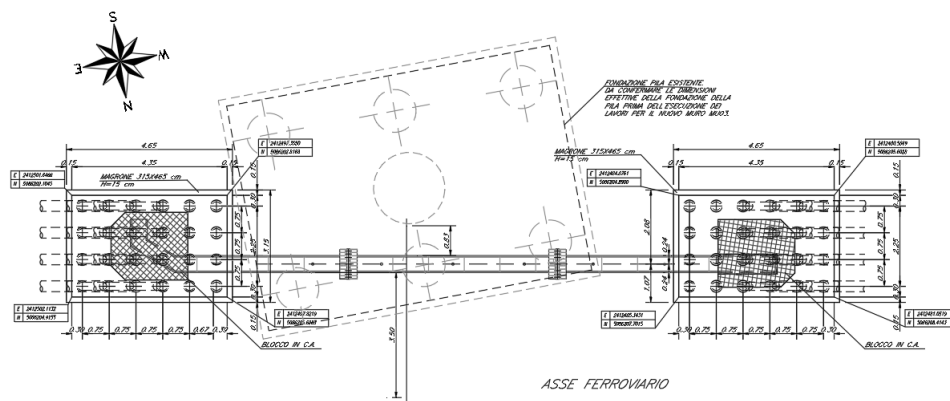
MU03 Planimetria generale muro opera di protezione con luce asse di 17.00 m.
